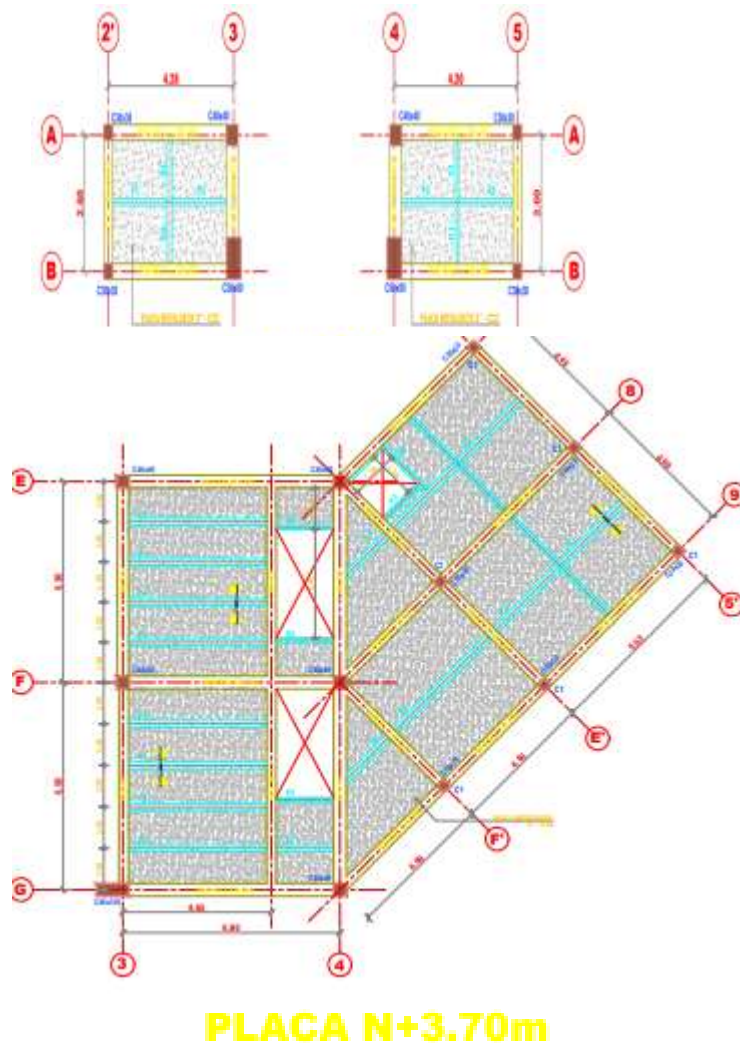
Detalles de las placas correspondientes a la Sección 1
